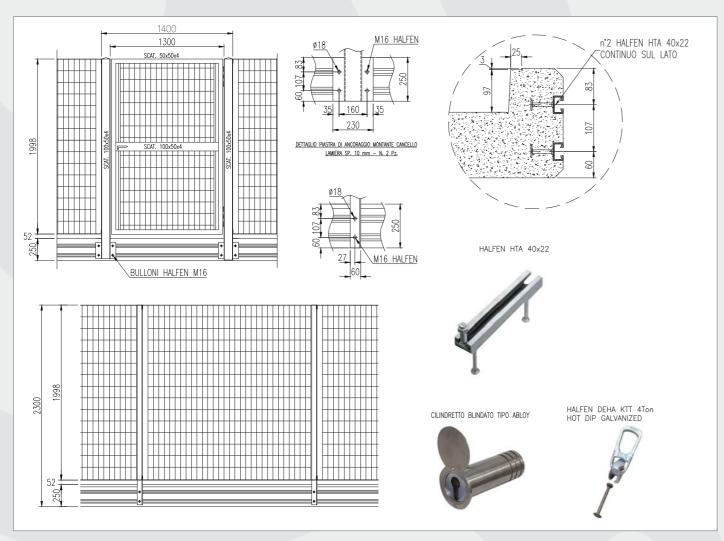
Collegamento moduli FAST SITE® SYSTEM 36
